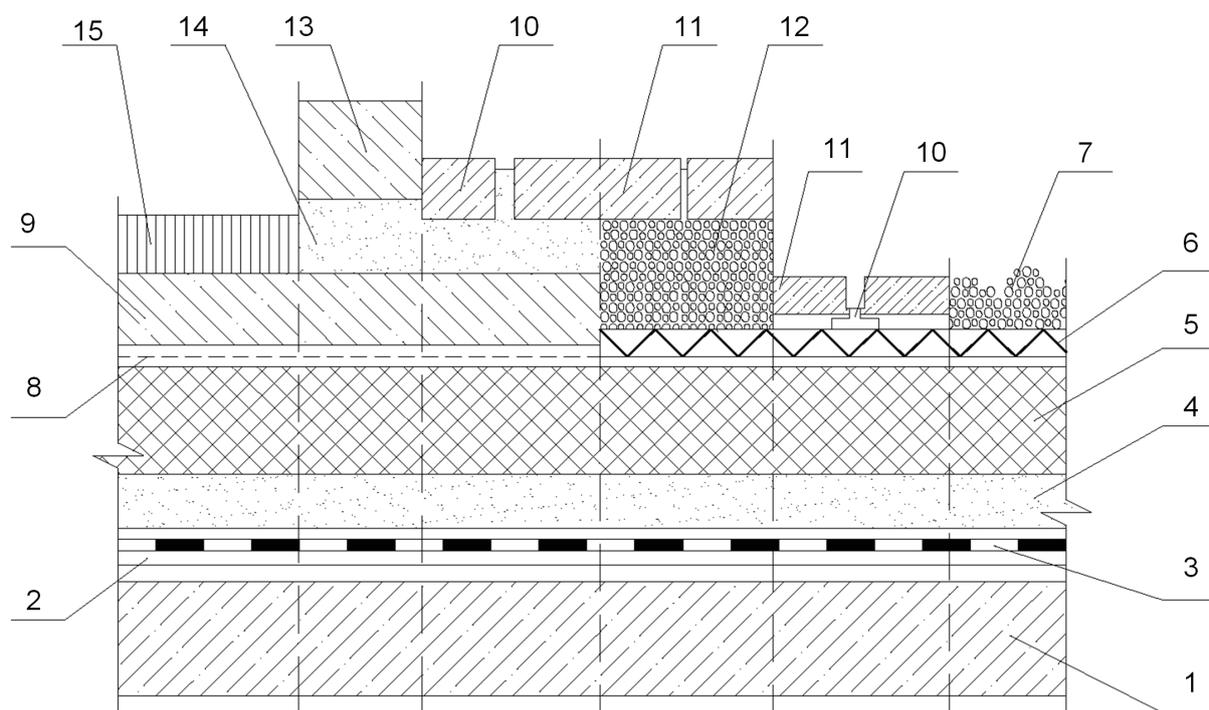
Устройство гидроизоляции воронки на утепленном покрытии стилобата
